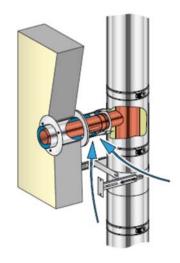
Mise en place d'un conduit de liaison, 3CE P MULTI + à l'extérieur d'un bâtiment
